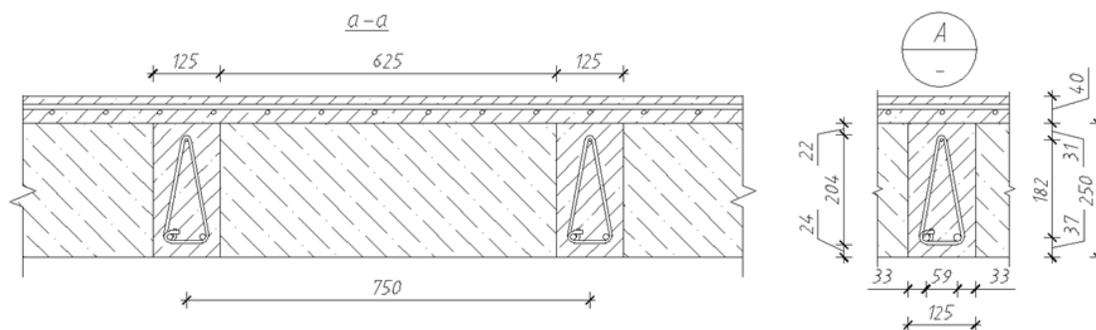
2 вариант устройства сборно-монолитного перекрытия.
